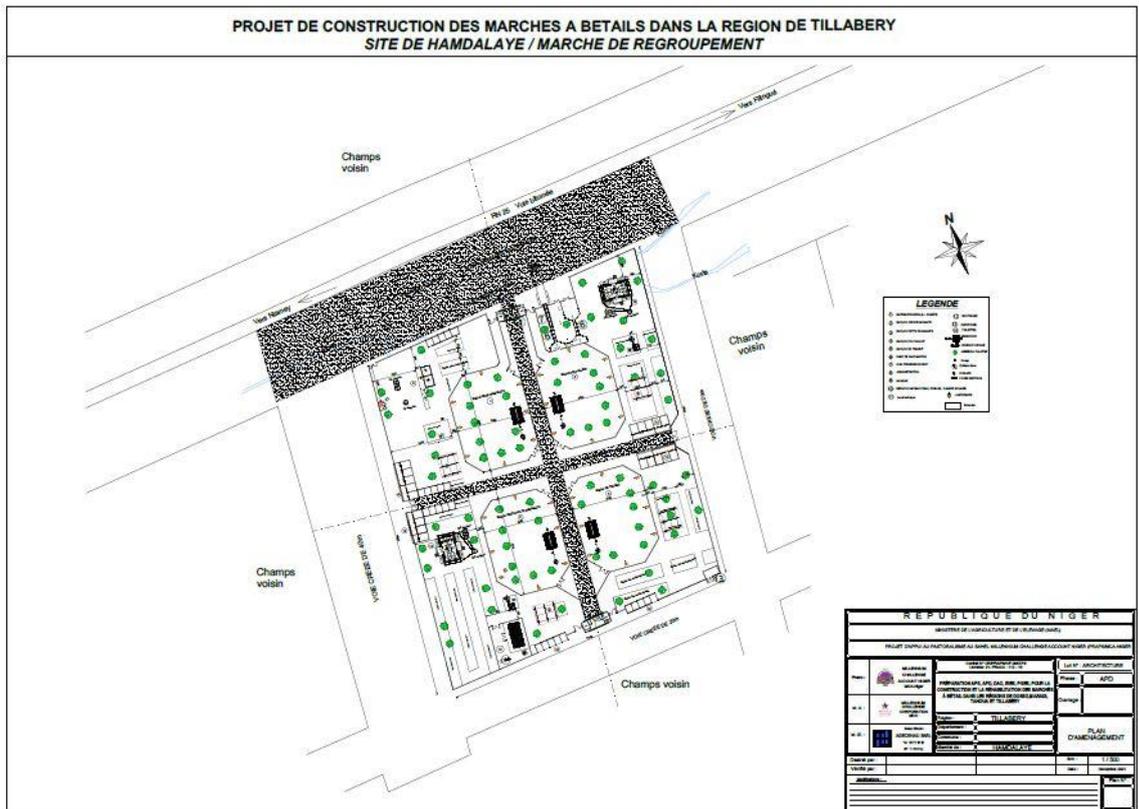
Plan de masse et d'aménagement du marché de regroupement de Hamdallaye
